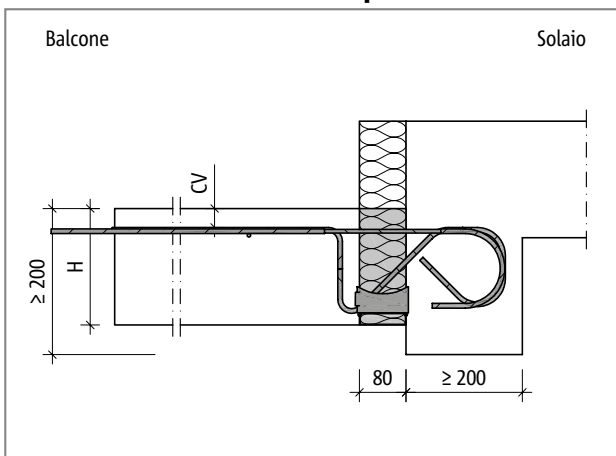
Schöck Isokorb® tipo K-UZ: balcone con abbassamento di quota e isolamento esterno
